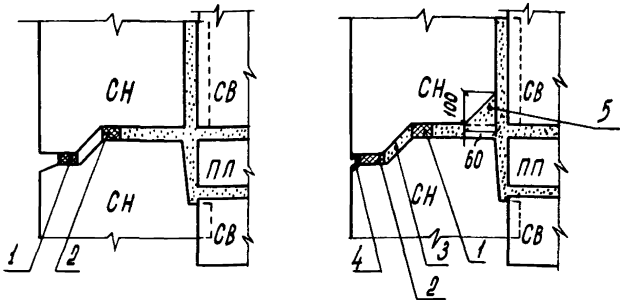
Герметизация и утепление горизонтальных стыков панелей наружных стен (на примере домов серии ИЛГ-602):
